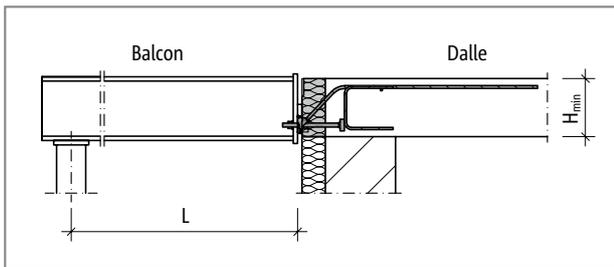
Schöck Isokorb® T type SQ : Système statique
